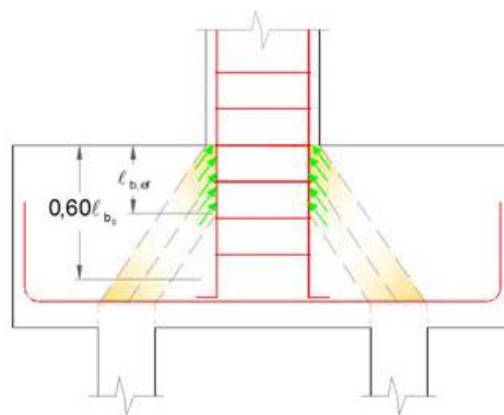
Ancoragem da armadura de pilares (Fusco, 1994)
